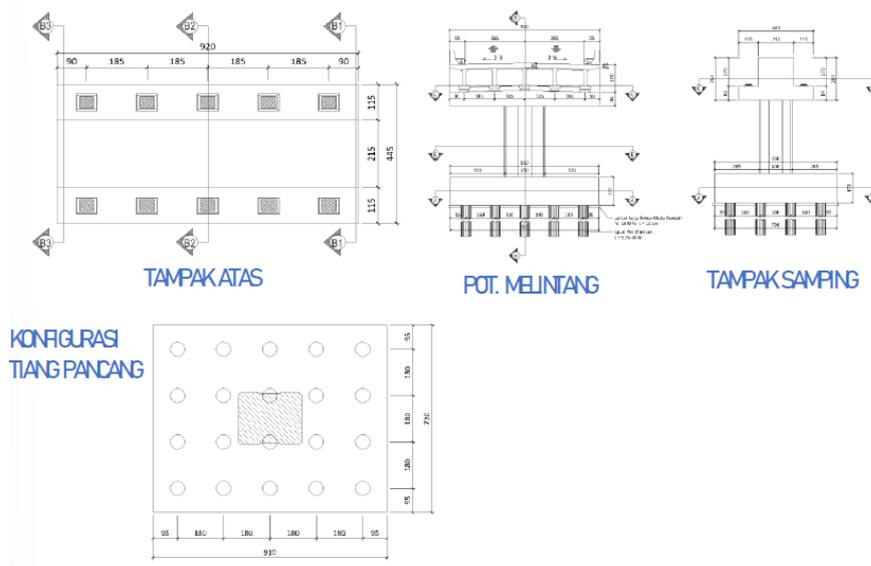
4 Gambar Ilustrasi Tipikal Struktur Voided Slab
